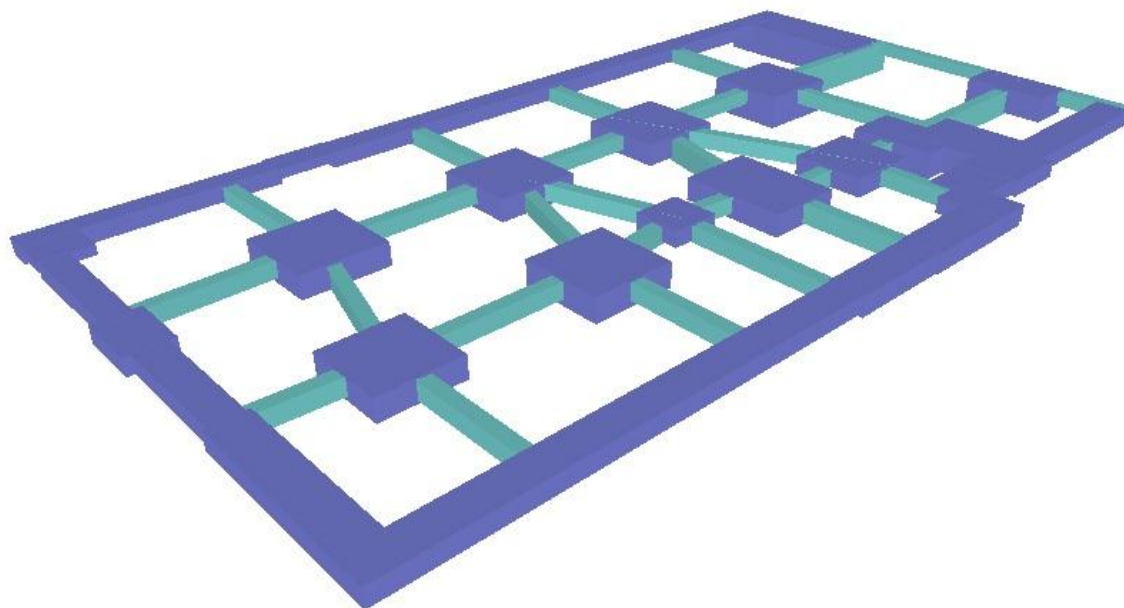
Pormenor de sapatas e vigas de fundação, CYPECAD
